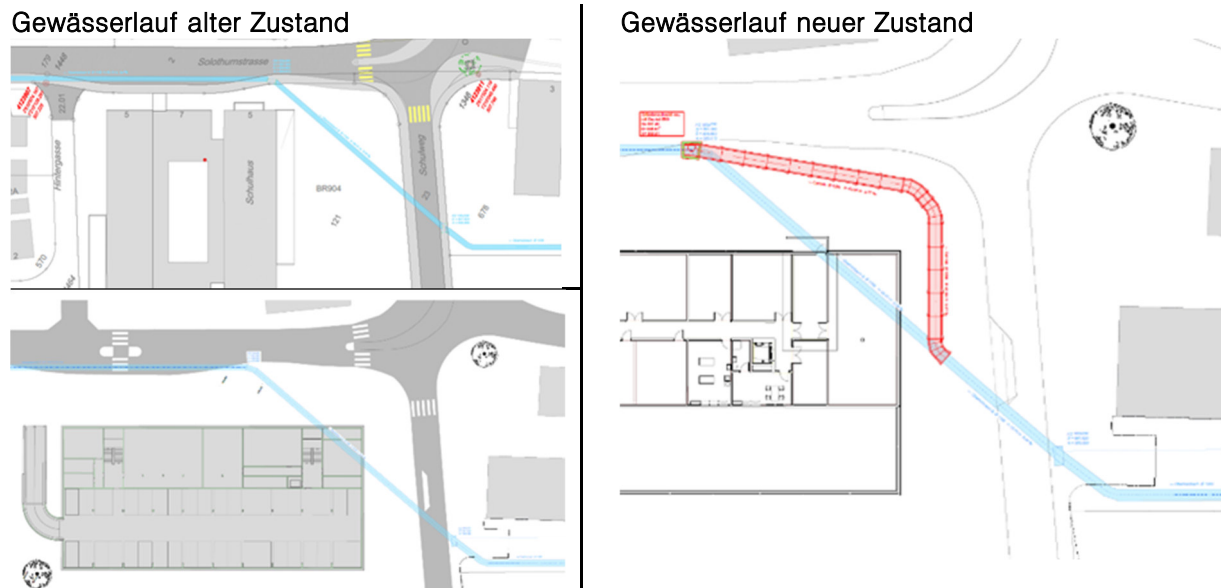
Umleitung Grützbachkanal vor und nach dem Neubau (Stand Vorprojekt)
